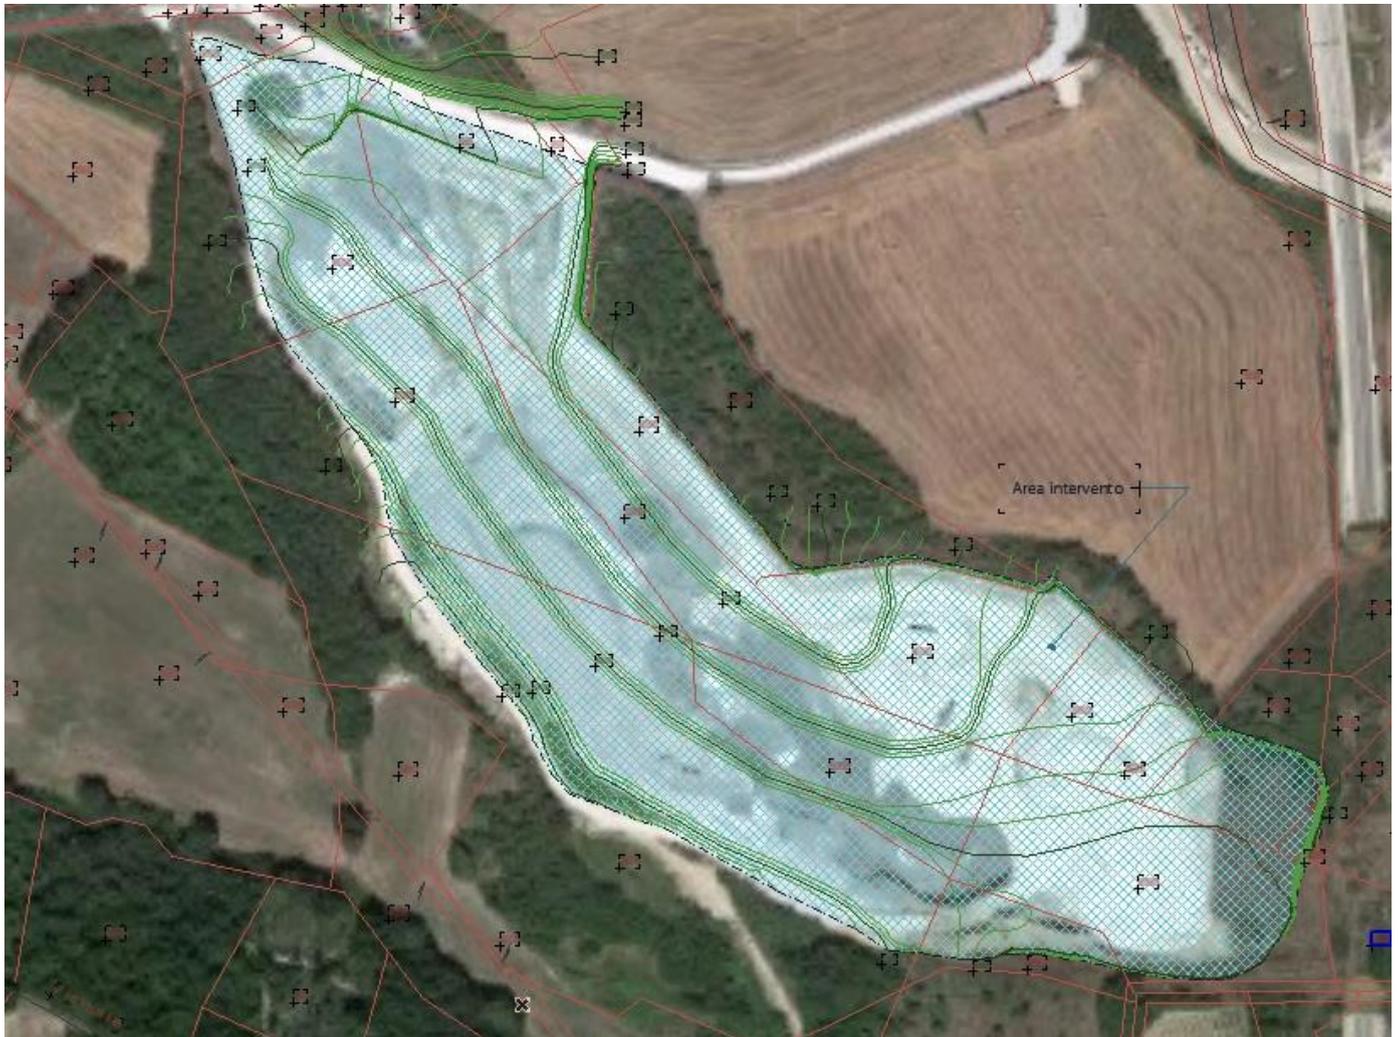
Sovrapposizione area di cantiere su ortofoto 2018
